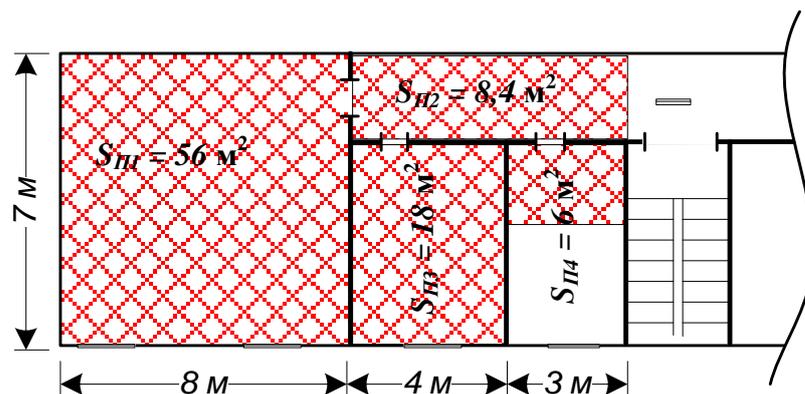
Развитие пожара по прямоугольной форме по помещениям
